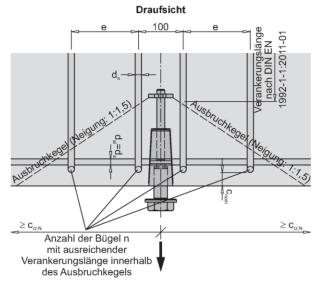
Einbausituation Stirnseite - Zugbeanspruchung mit Rückhängebewehrung - Bewehrungslage
